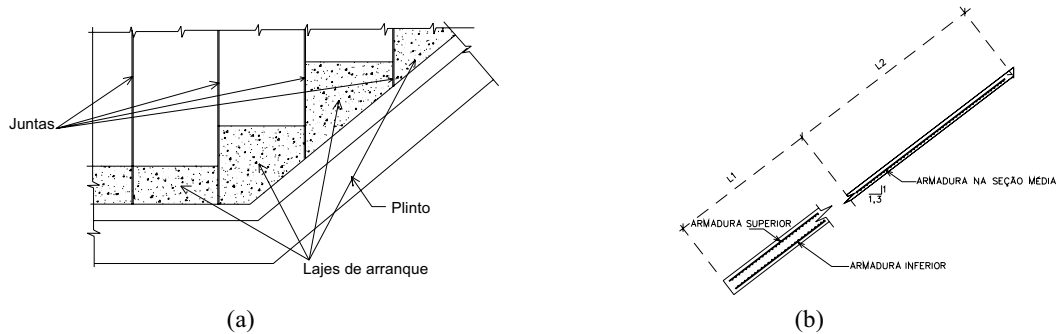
(a) Planta da face; (b) Disposição das armaduras (Goulart et al., 2003).
